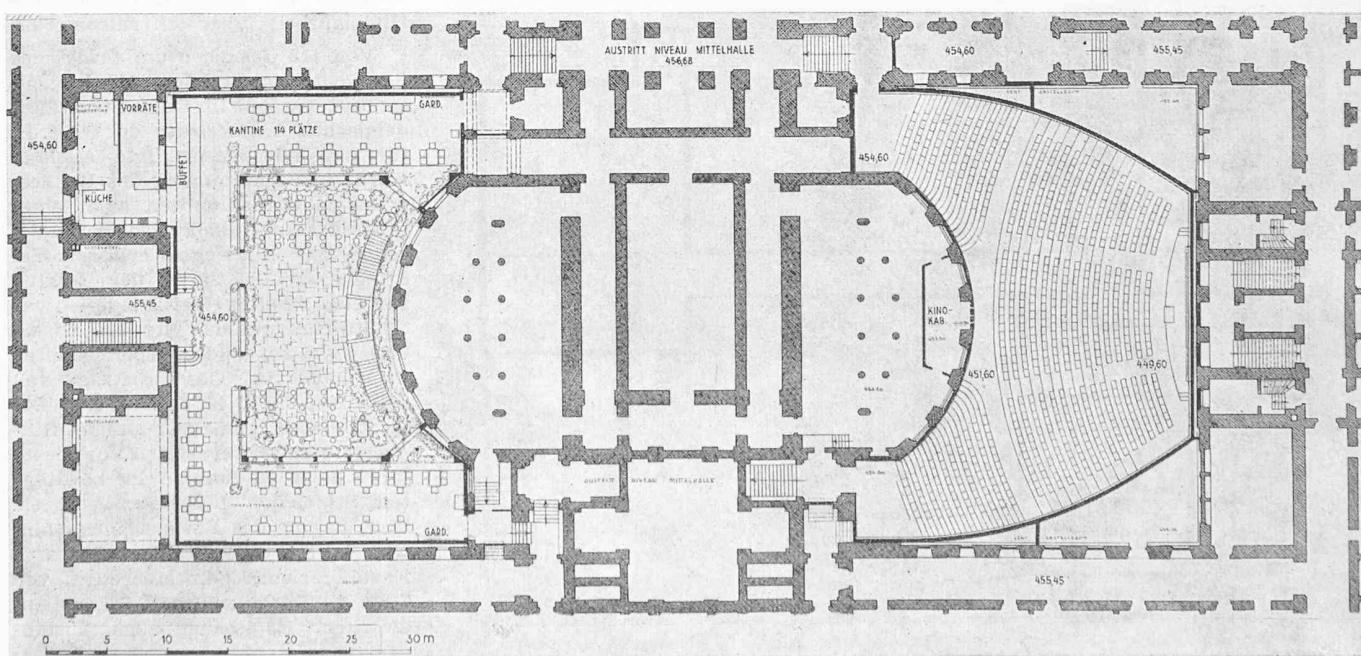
Hauptgebäude der E. T. H. Teilgrundriss A-Geschoss, 1:600. — Arch. Prof. Dr. H. HOFMANN
